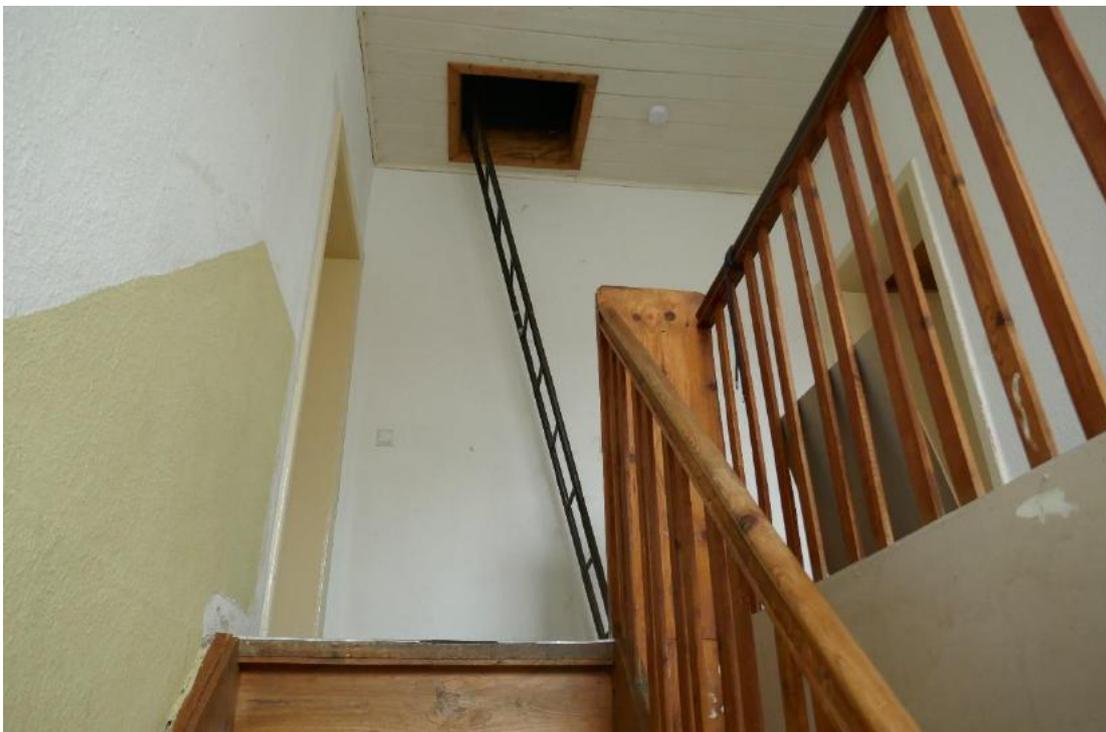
, beispielhaft Treppenhaus, Zugang zum nicht nutzbaren Dachraum mit Anstelleiter
